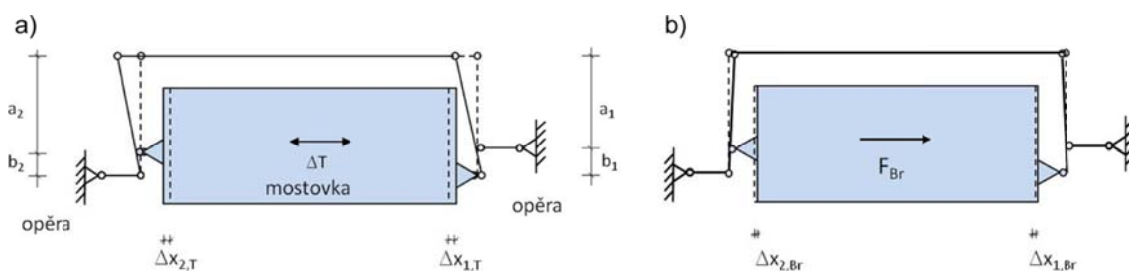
Řídicí tyč na mostu v Drážďanech, detail u opěr
